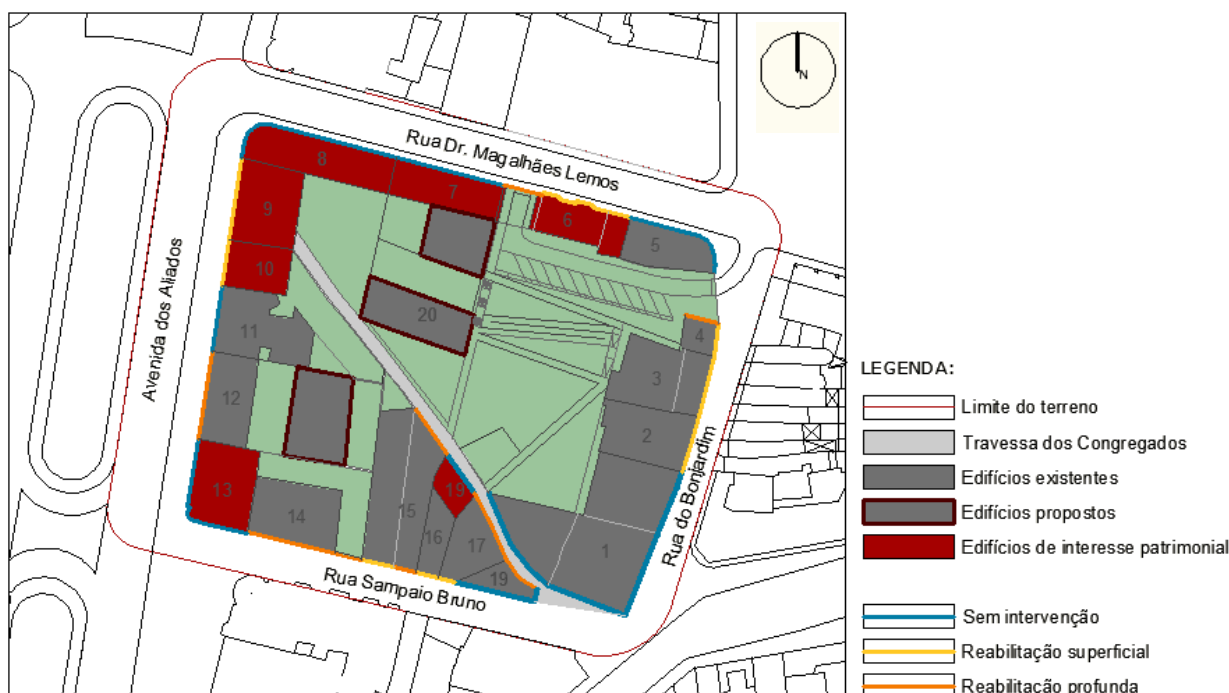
Planta do nível de intervenção das fachadas principais.
